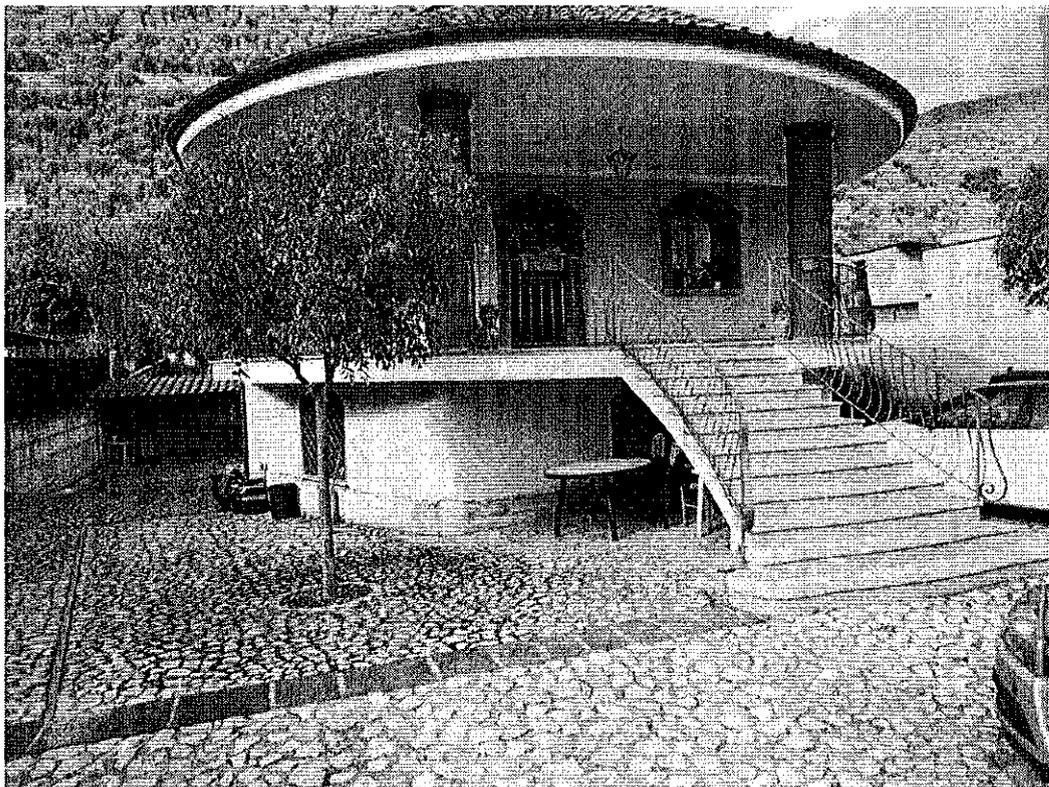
< Prospetto frontale dell'unità immobiliare: vista Sud-Ovest – Accesso piano Seminterrato >
